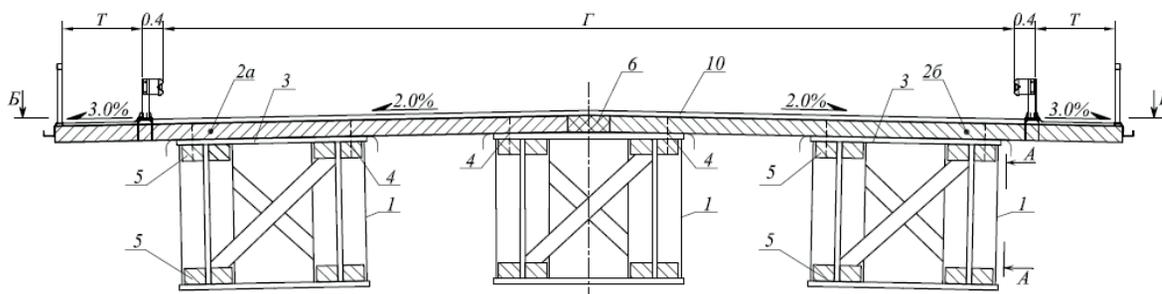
Пролетное строение с железобетонной плитой проезжей части
